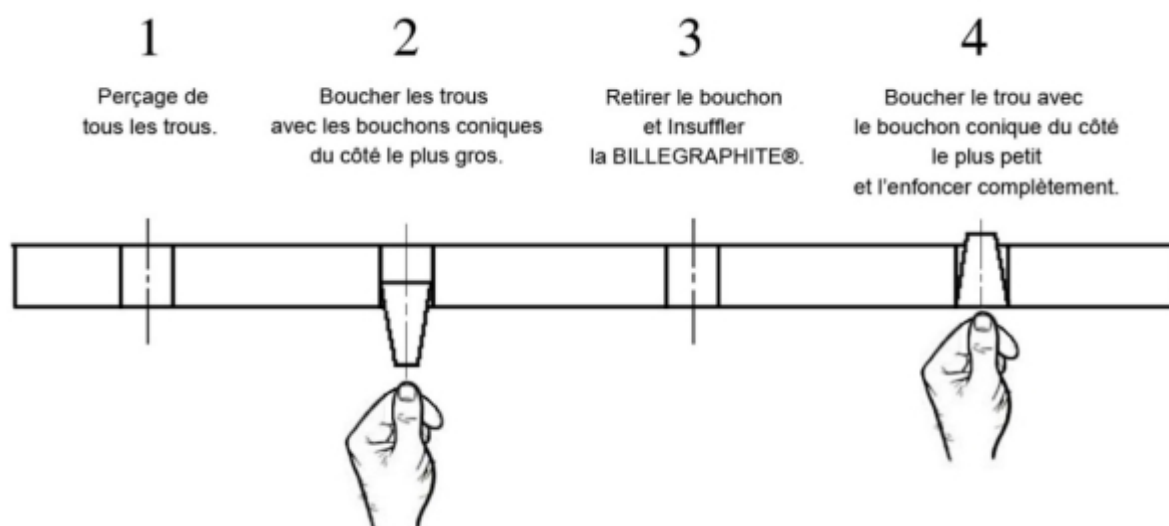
Etapes d'insufflation par la sous-face du plancher
